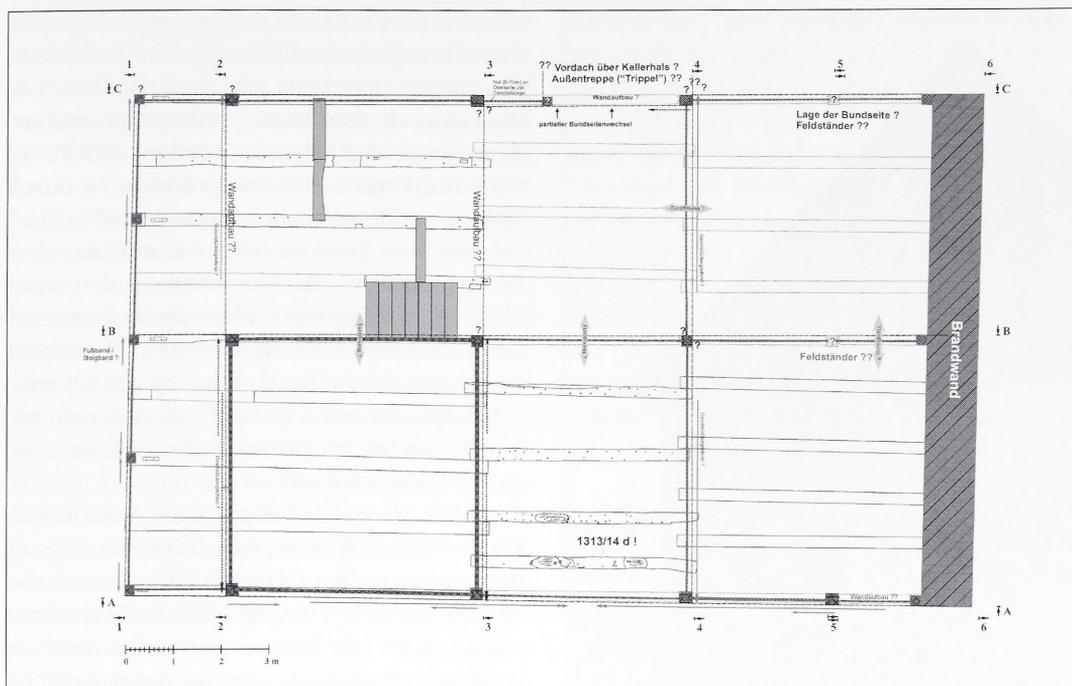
Reutlingen, Kanzleistraße 24. Grundrissrekonstruktion 1. Obergeschoss mit Deckengebälk Erdgeschoss/ 1. Obergeschoss im Zustand 1267 (d) (mit Ergänzung 1313/14 d).
